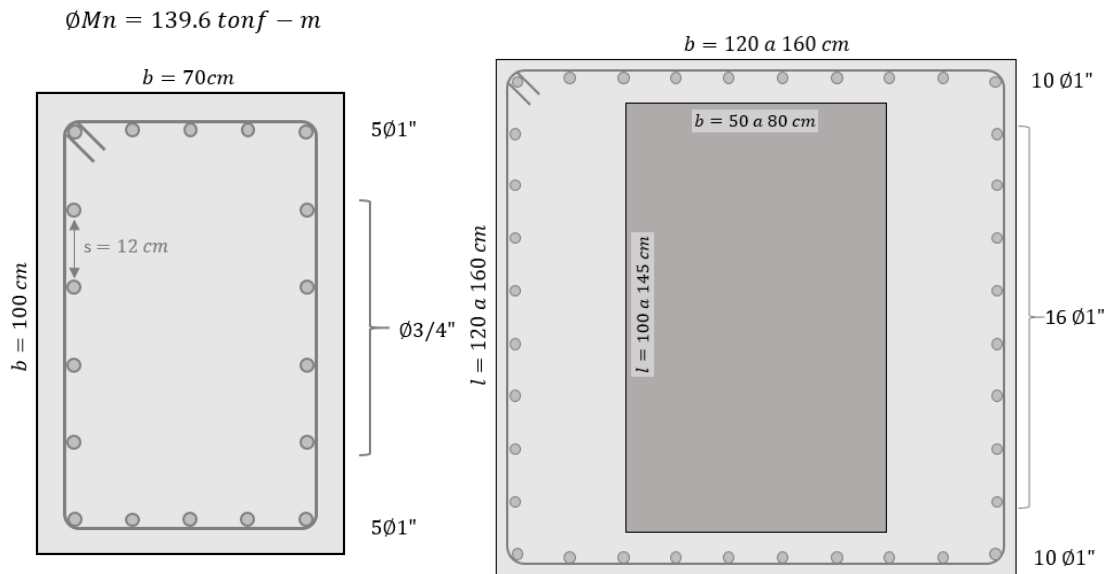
Sección de la viga de la interfaz de aislamiento y de la columna reforzada (Nivel aislamiento)
